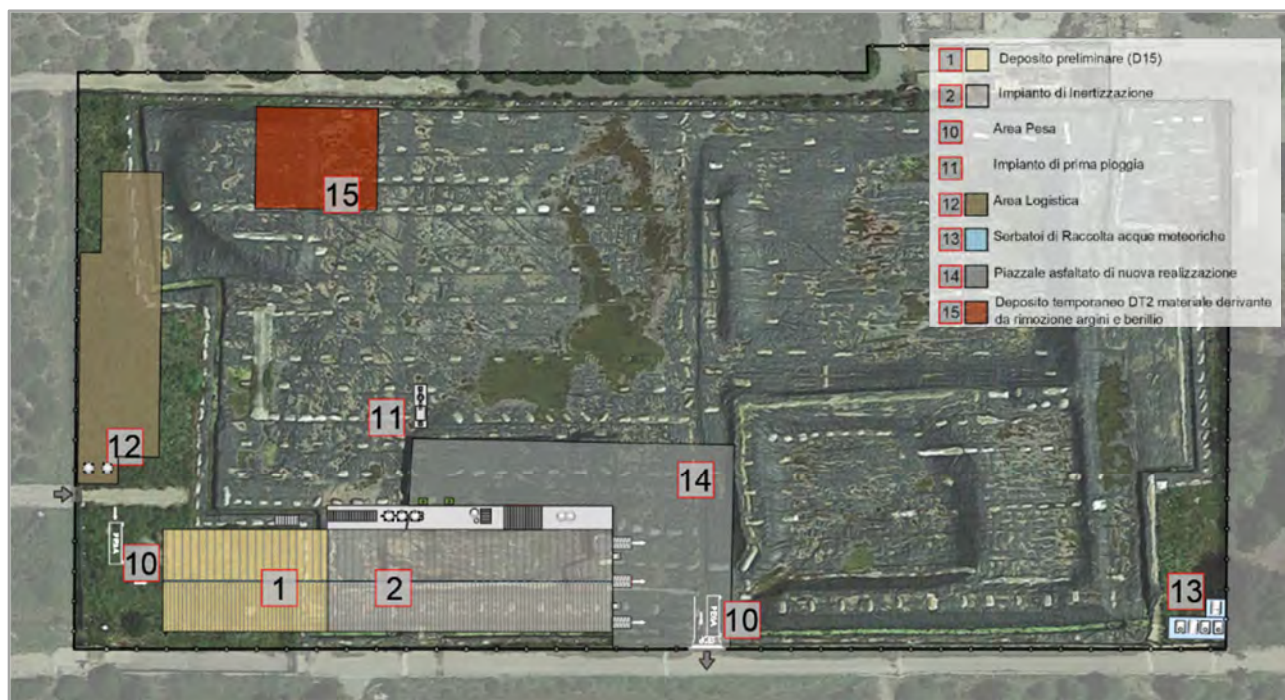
Ortofoto dell'area palte con individuazione di alcune aree di lavoro
